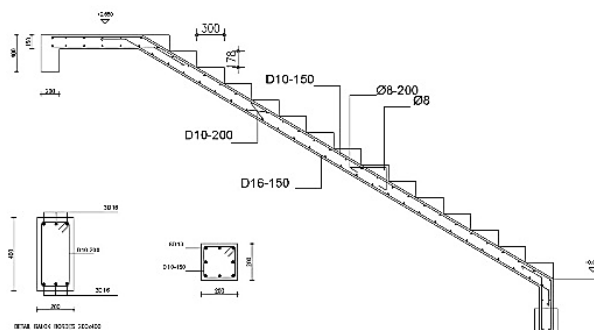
yaitu Denah Tangga Utama dan Gambar 3.20 Detail Tangga Utama. Gambar 3.19 dan Gambar 3.20 memperlihatkan denah *layout* serta
